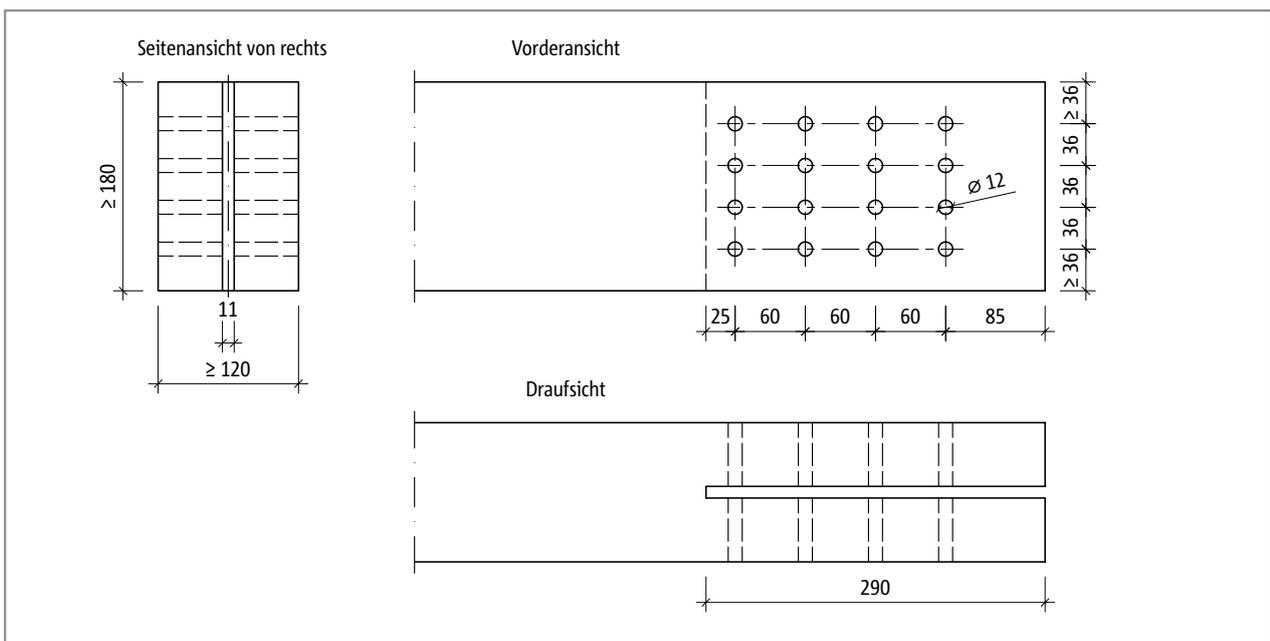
Schöck Isokorb® T Typ SQ mit Stahlschwert: Abbund des Holzbalkens
